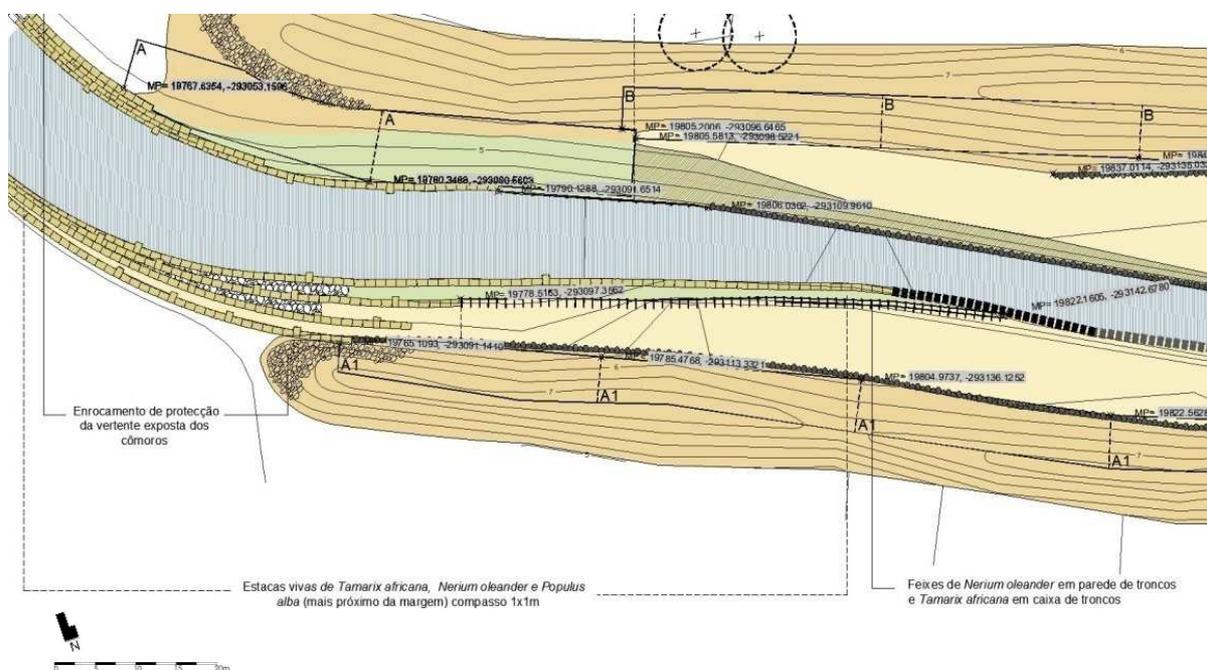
Exemplo de planta das técnicas de: contenção de taludes(localização coordenadas geográficas); estabilização de margens (revestimentos e sementeiras) e plantações. (base: Esc. 1/500).
